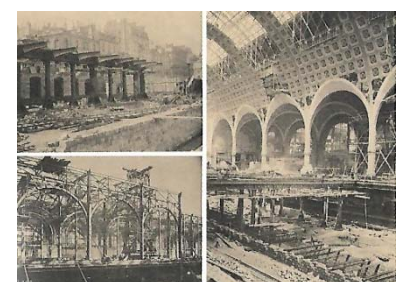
Fotografías de la construcción de la estación (1898 – 1900)
